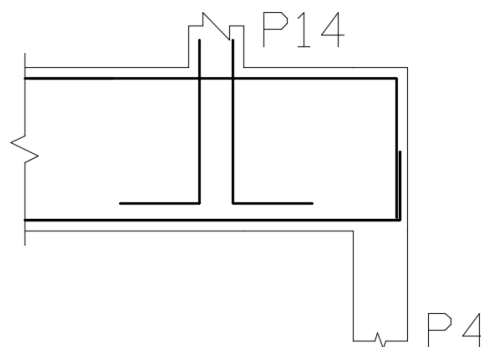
Viga com carga próxima ao apoio detalhada com o CAD/TQS
